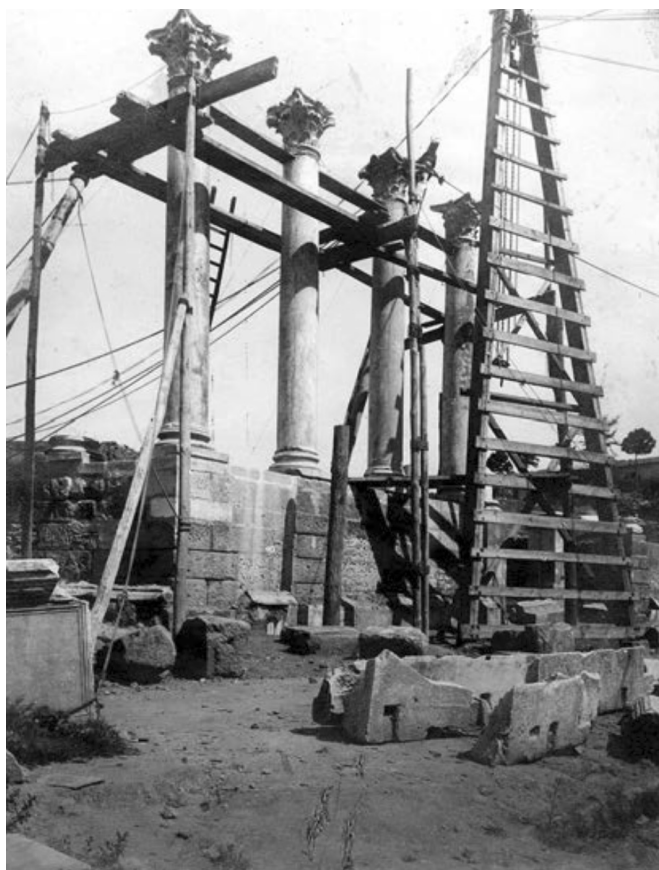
Fotografía de los primeros trabajos de reconstitución y puesta en pie de las primeras columnas del primer orden del frente de escena, 1921. (Archivo Gómez-Millán Vela).
